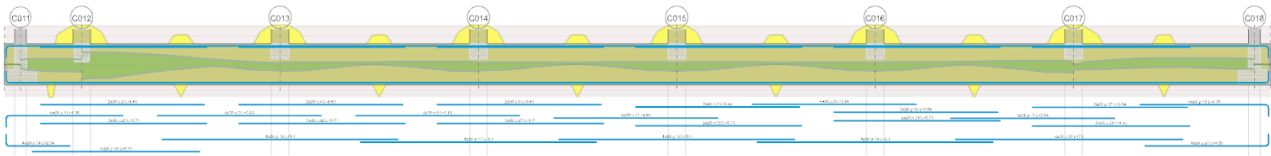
Geometria tipo trave a T rovescia di fondazione
